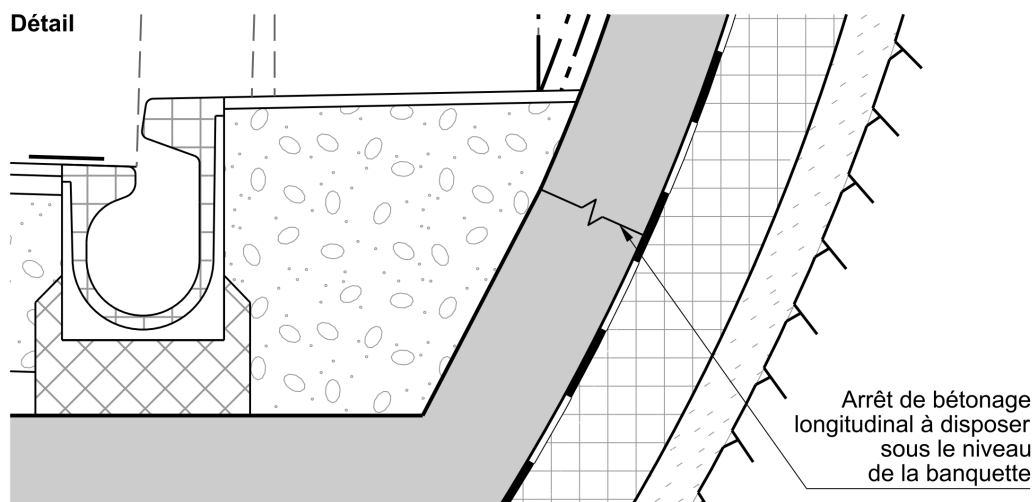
Exemple d'arrêt de bétonnage longitudinal dans la zone de la banquette de l'anneau intérieur d'une voûte
